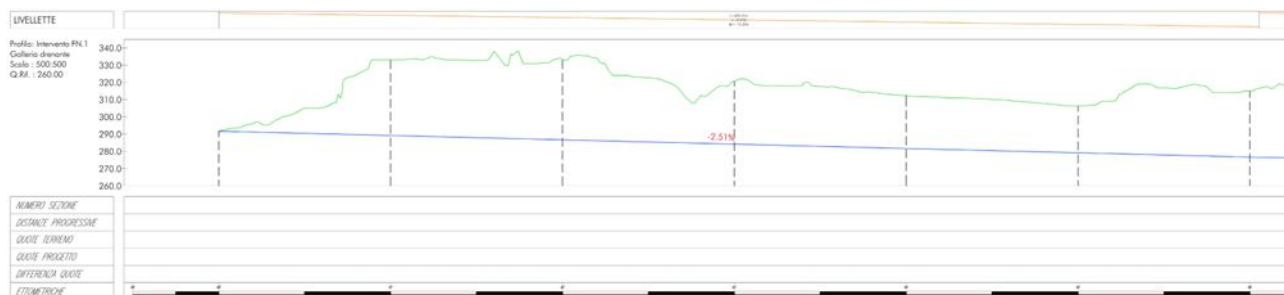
Parte 1 del profilo altimetrico d'asse dell'orizzontamento inferiore della galleria drenante.
